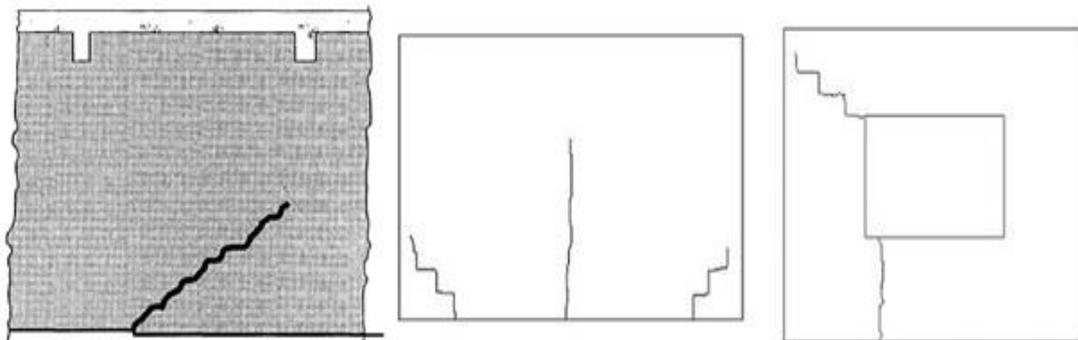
Formas características de fisuras en mampostería por asentamiento diferencial de fundación.
